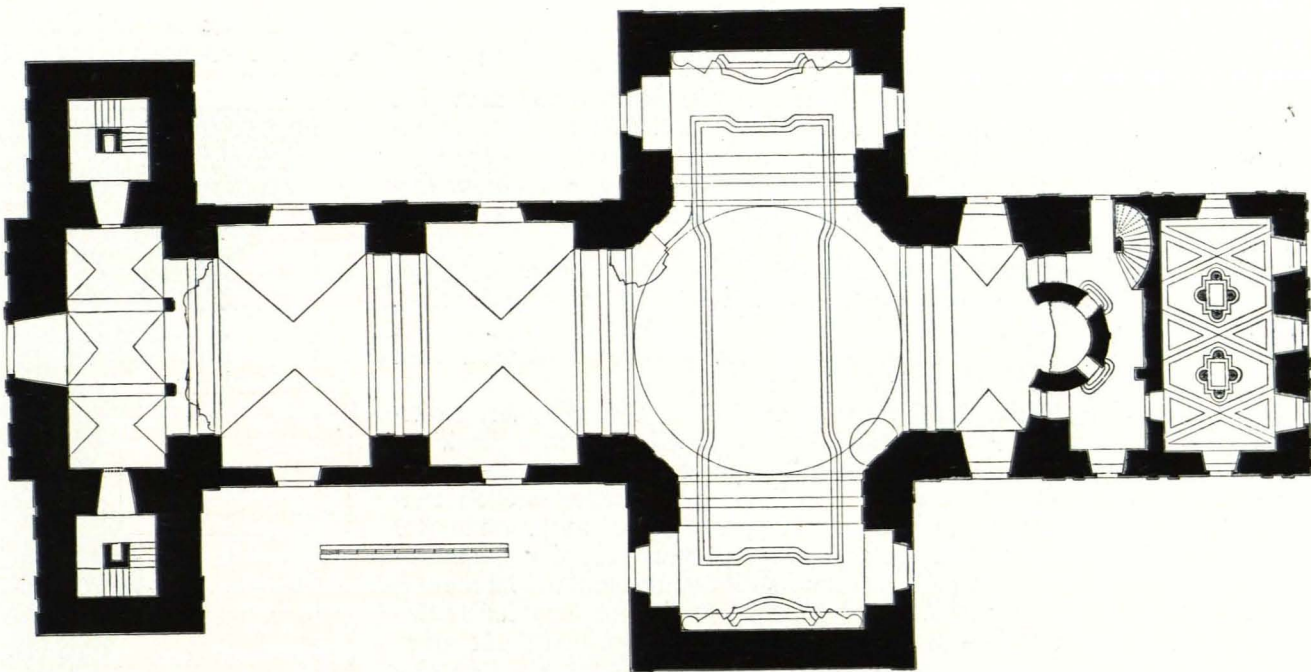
Maria-Taferl, Wallfahrtskirche, Grundriß 1 : 400 (S. 98)
